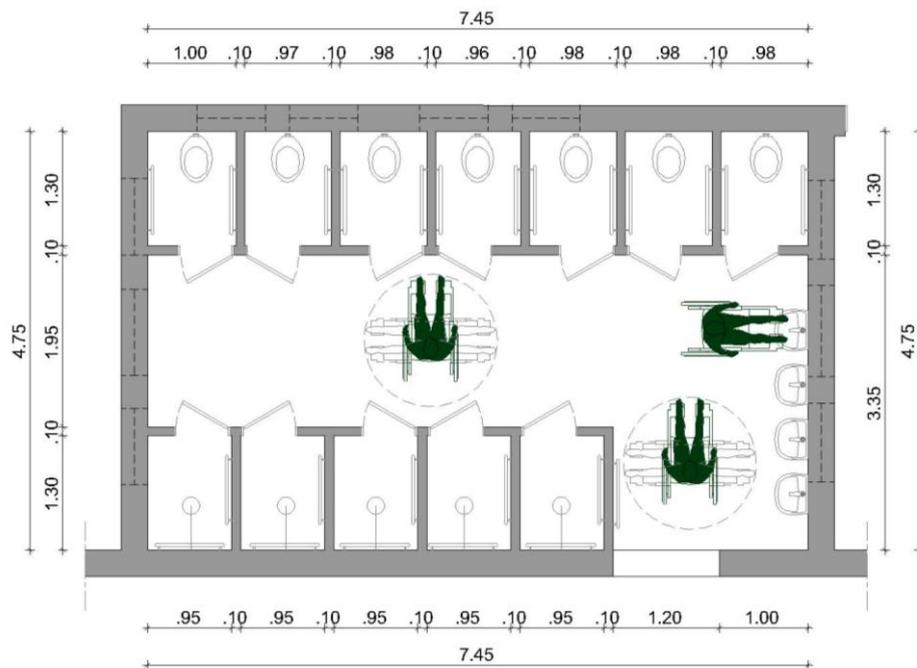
ILPI 2 - Planta baixa banheiro coletivo masculino B.
